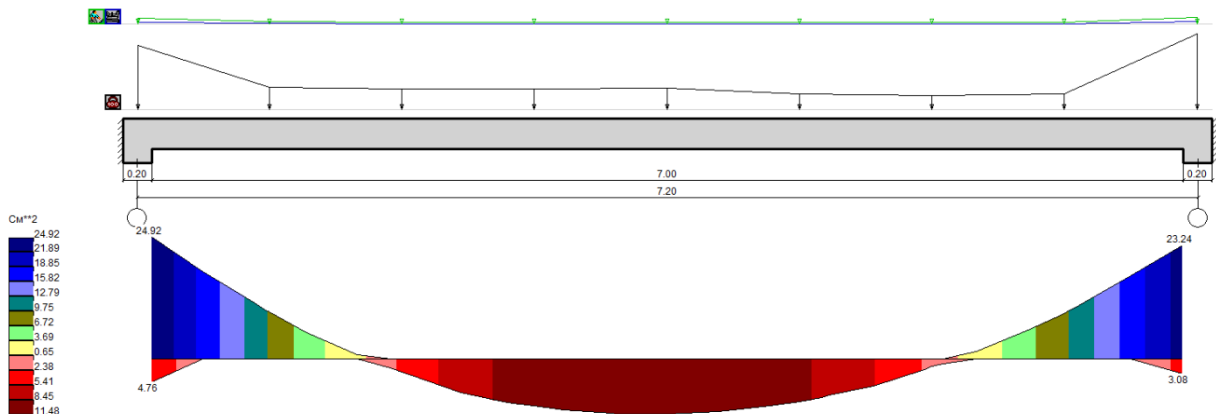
Поздовжнє армування балки перекриття типового поверху
